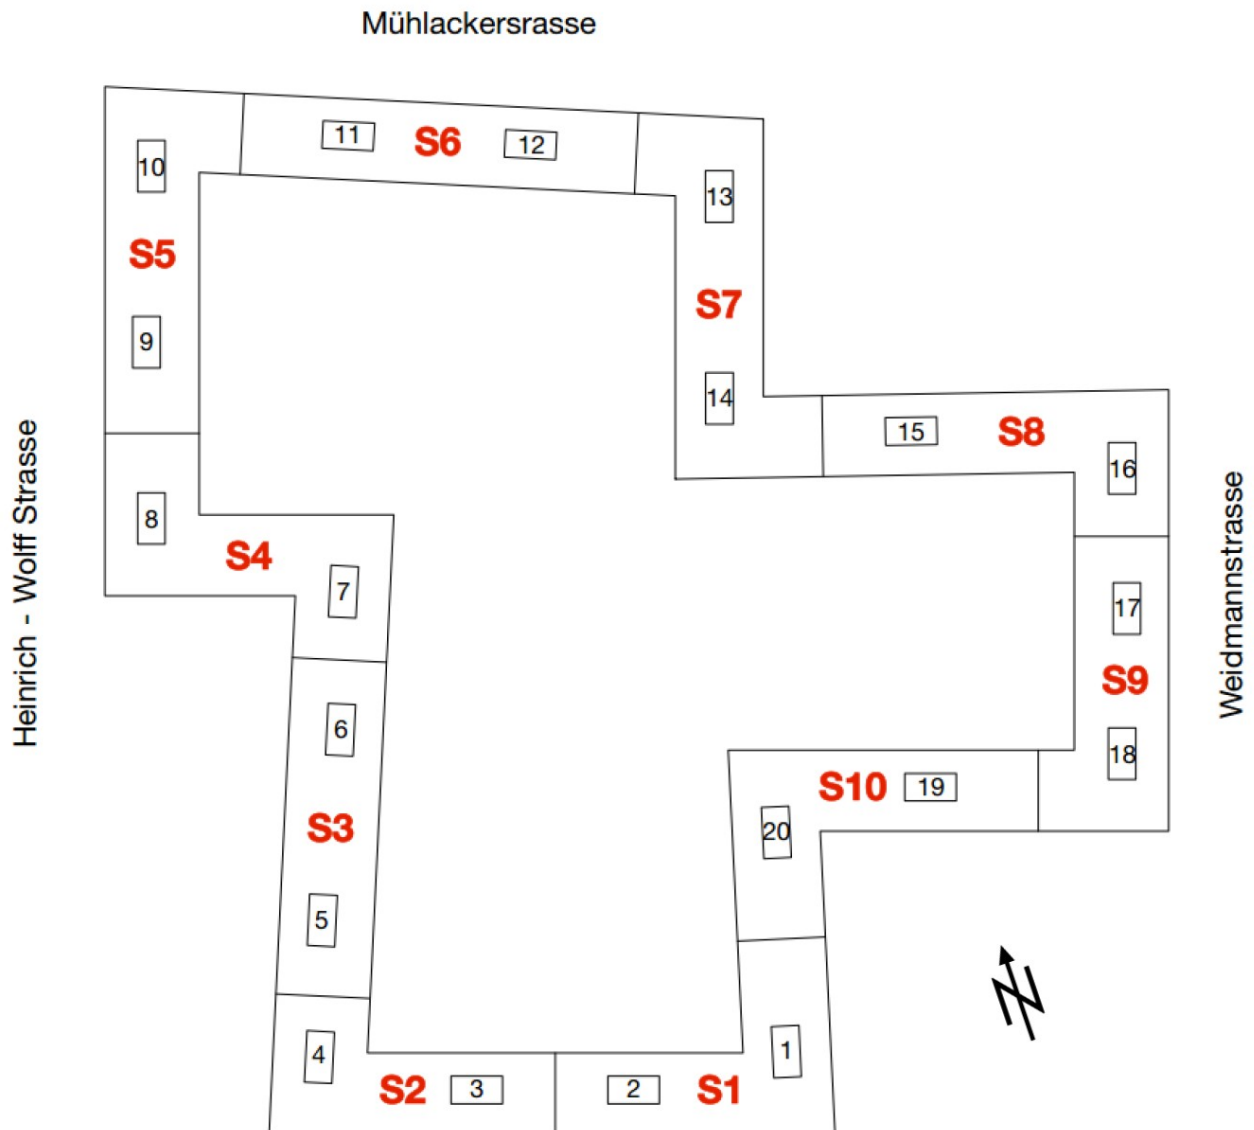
Grundriss der Siedlung Klee (Knapkiewicz & Fickert AG 2008)
